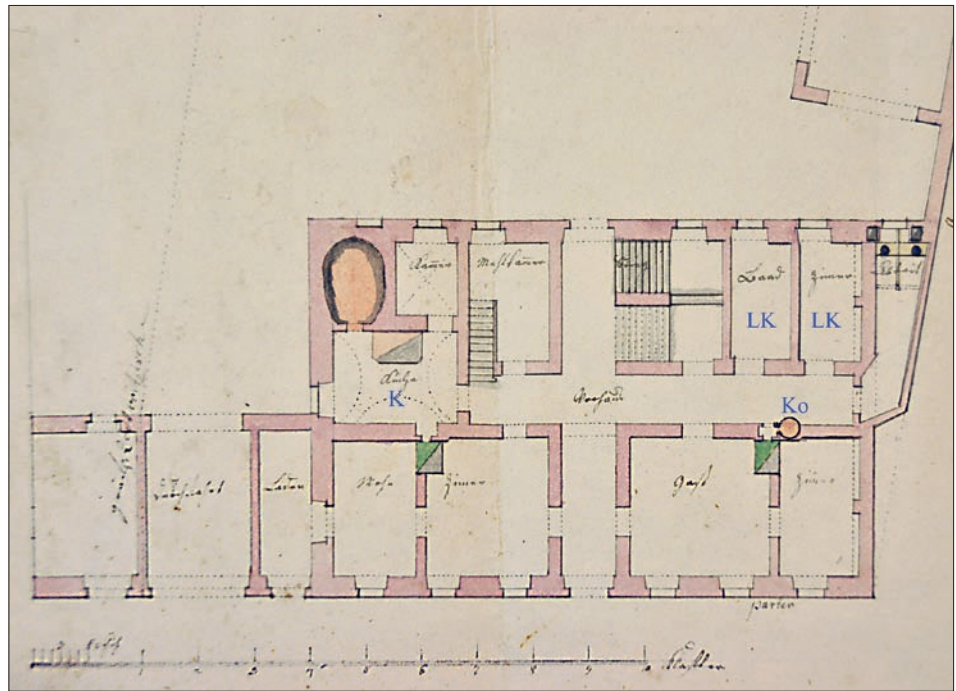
Františkovy Lázně, dům čp. 39 zvaný U zlatého hada a čp. 40 dům zvaný Zlaté srdce, stavební plán, 1820, projekt Georg Adam Jäger, půdorys přízemí, K – kuchyně, Ko – kotel, LK – lázeňská koupelna (SOKA Cheb).
